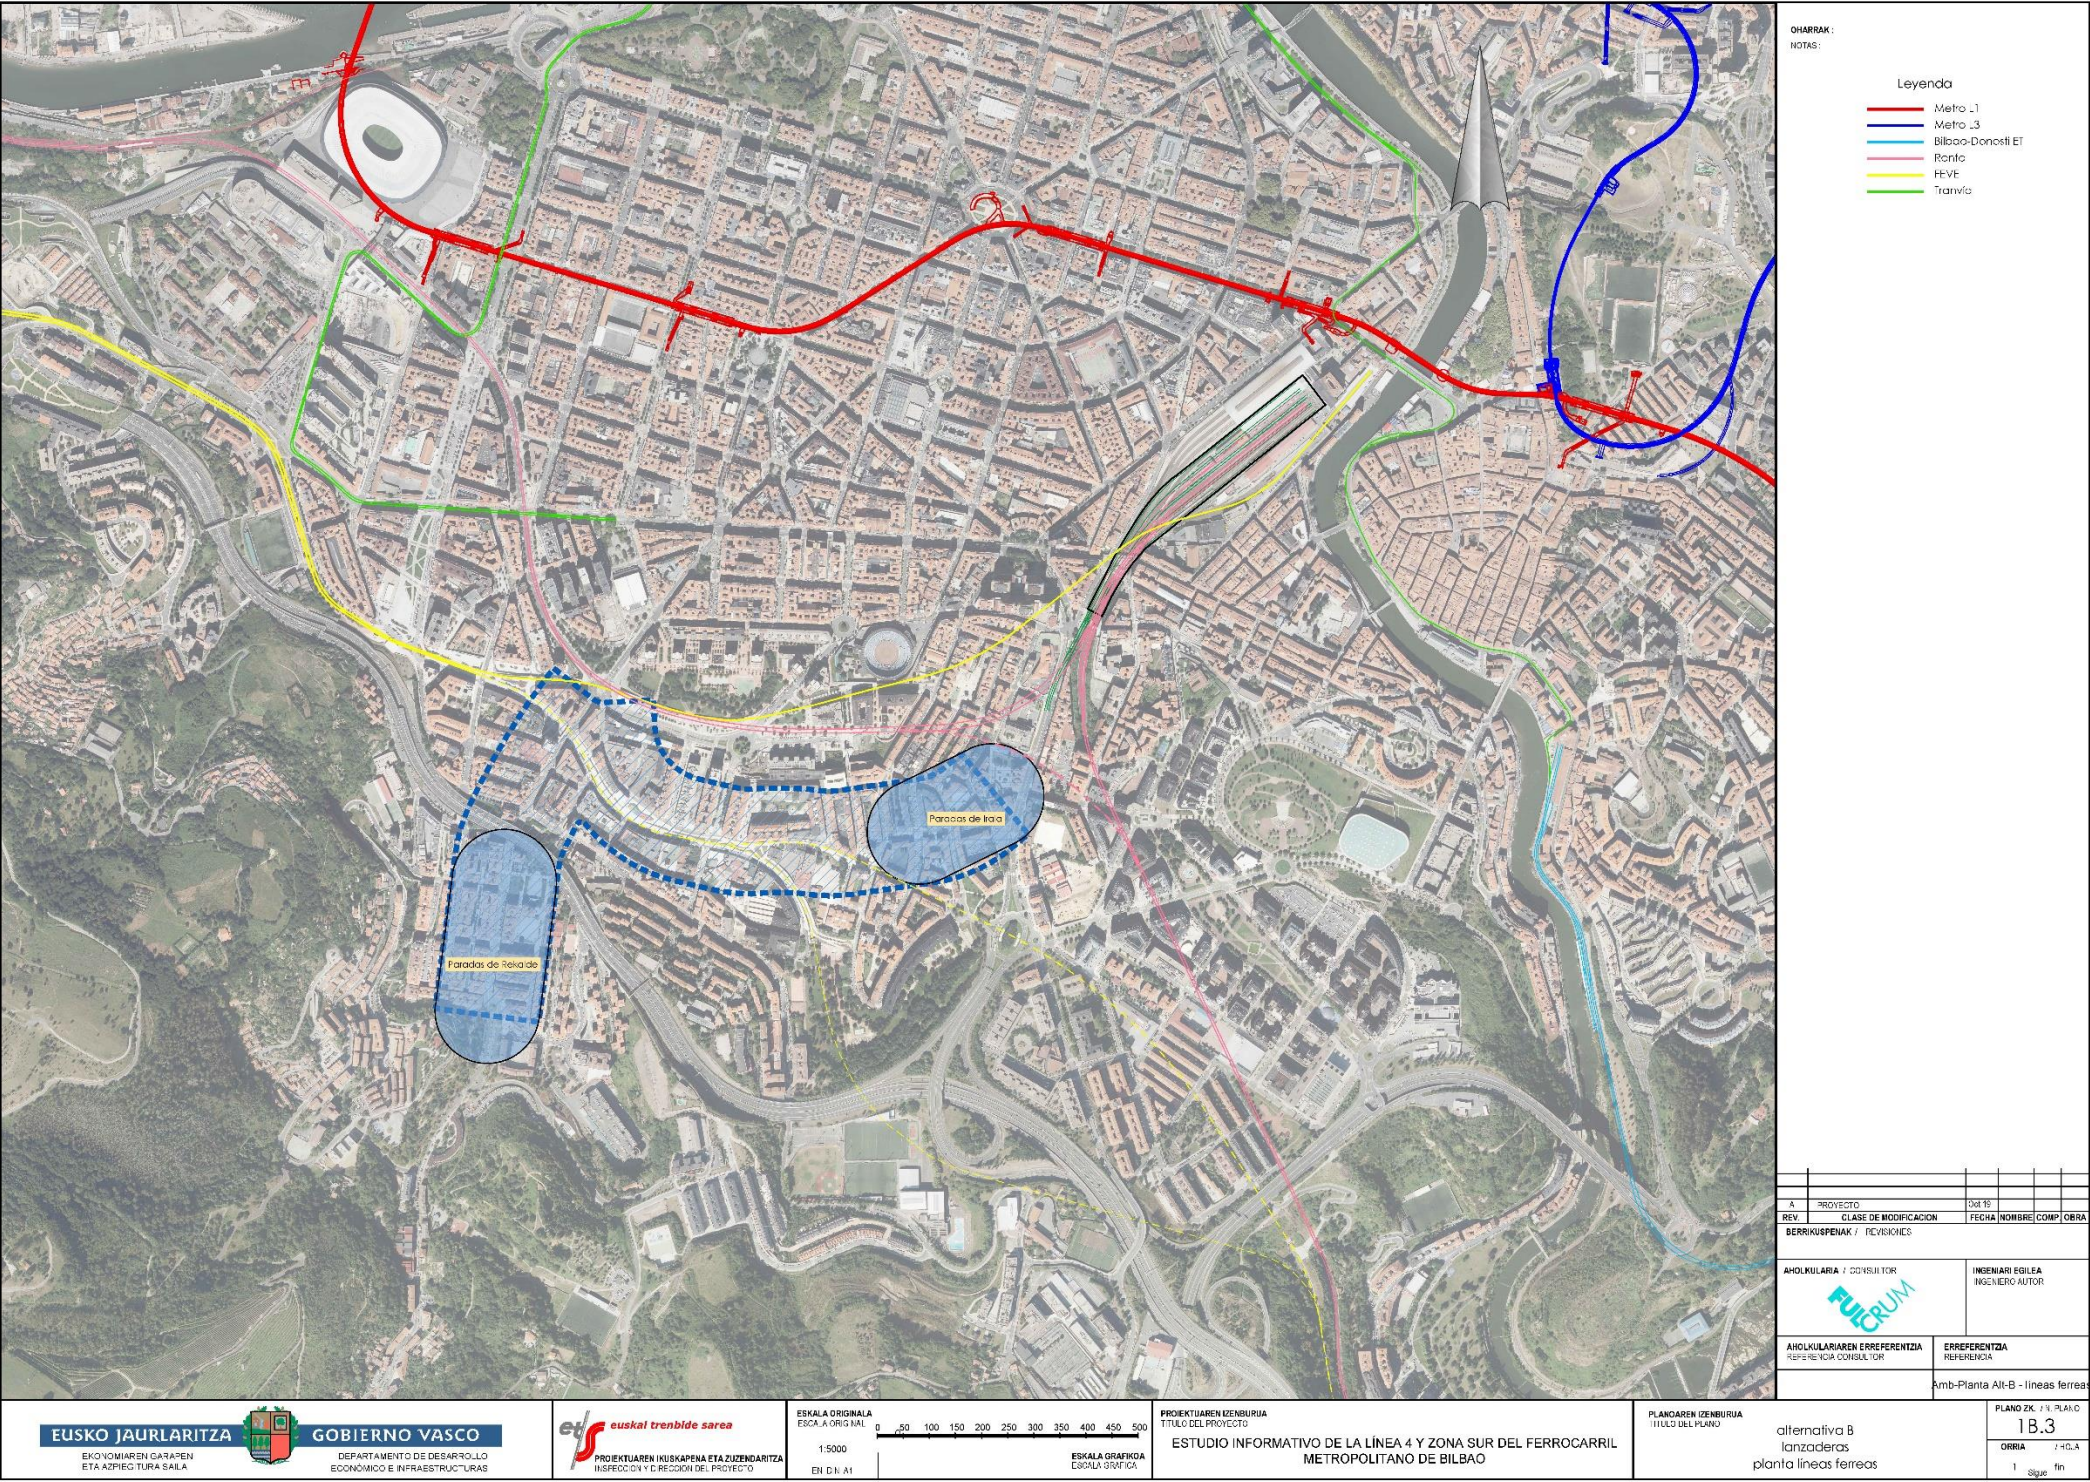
Planta de las líneas férreas alrededor de la zona de estudio de la Alternativa B.
